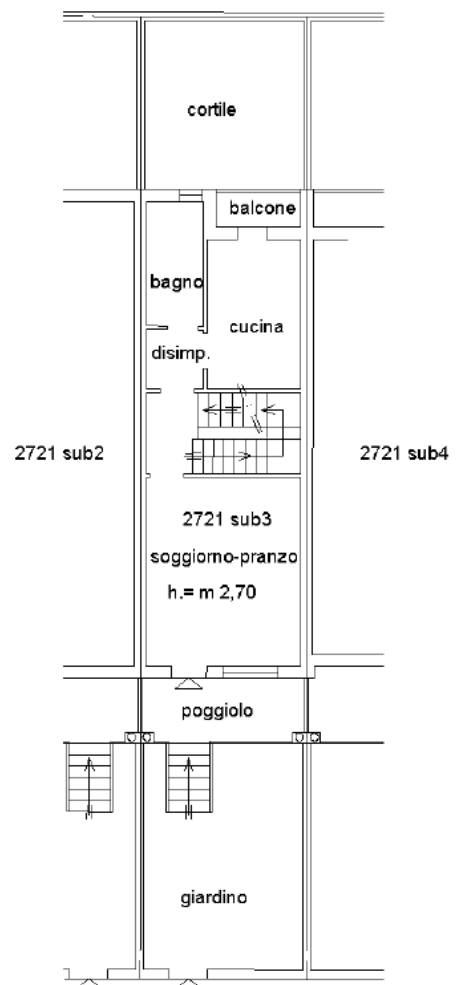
Stralcio planimetria catastale in atti (fuori scala).
